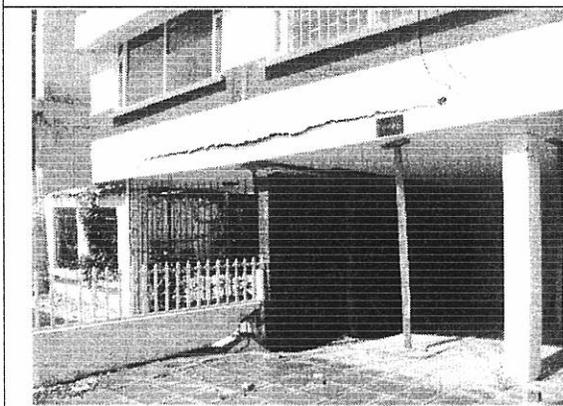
Agrietamientos y deformaciones en fachada.
